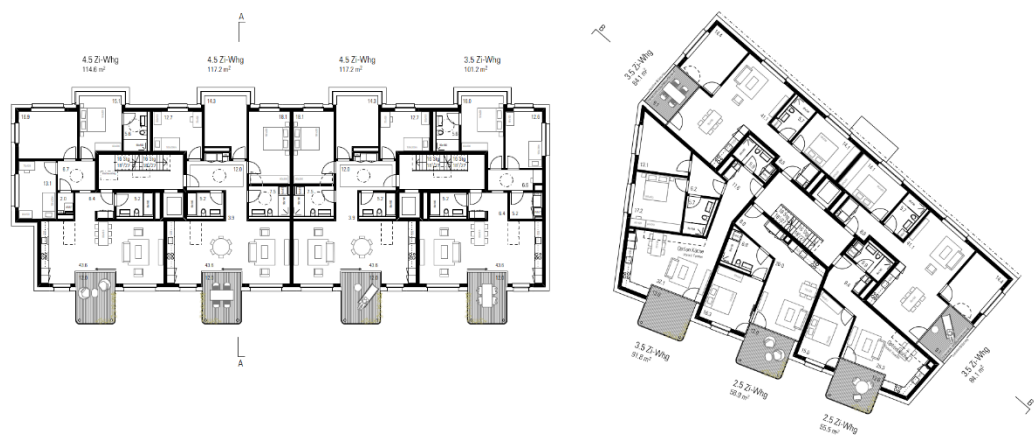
Grundriss 1.-3. OG (Quelle: Galli Rudolf Architekten)
